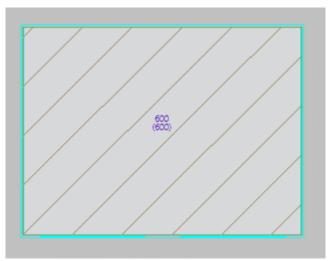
Imagen de la planta baja del edificio 600 en IFC Builder (Fuente: Elaboración propia)
